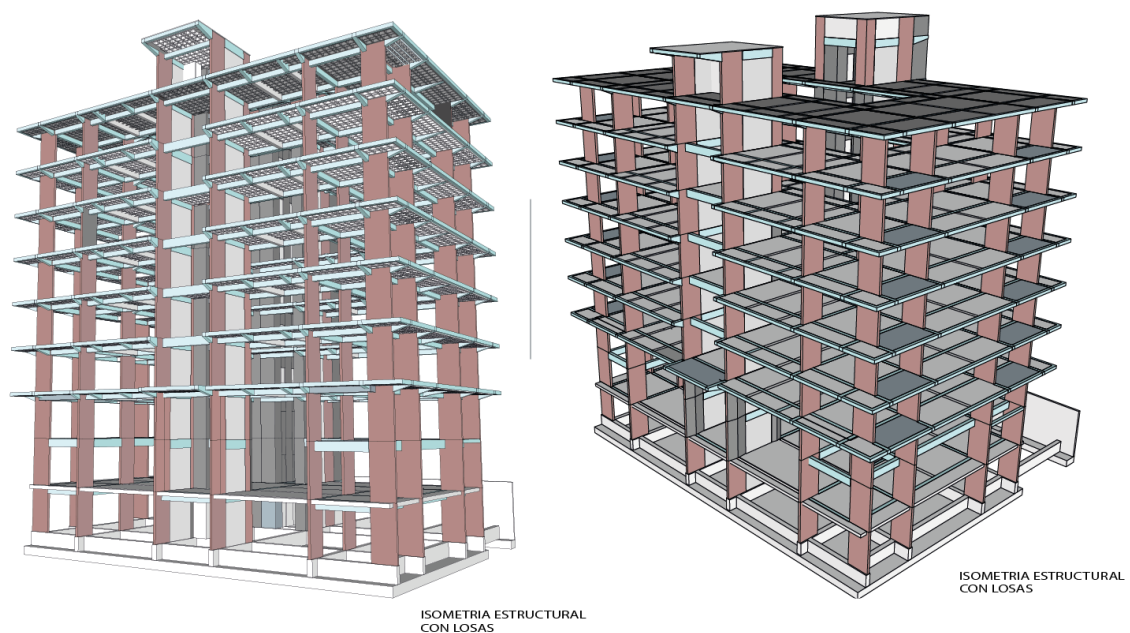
3D estructura Vivienda colectiva flexible (Jordan Baldassari, 2018)
